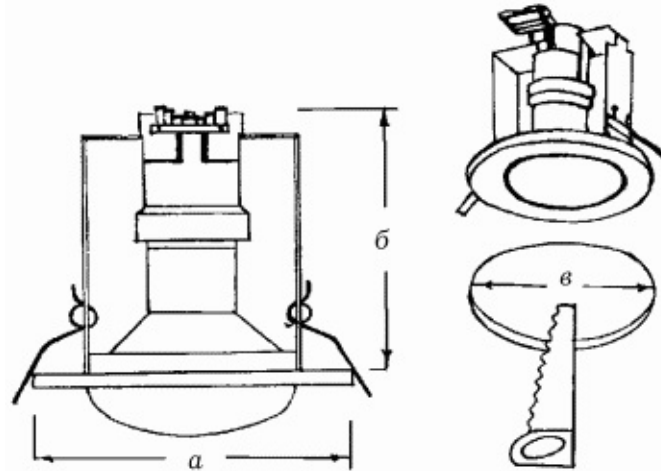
Точечный неповоротный светильник под лампу накаливания П-образной формы: а – диаметр светильника; б – глубина установки; в – диаметр отверстия.
